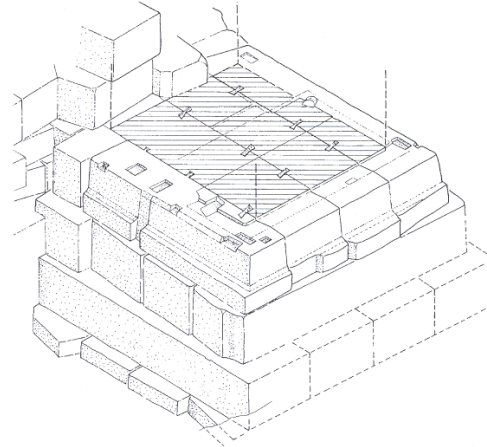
Przekrój przez fundament. A – splantowana powierzchnia skały, B – narys określający szerokość ściany fundamentów, C – bloki fundamentowe, D – zasyp z piasku i gruzu, E – płyty posadzki, F – bloki licujące ściany
